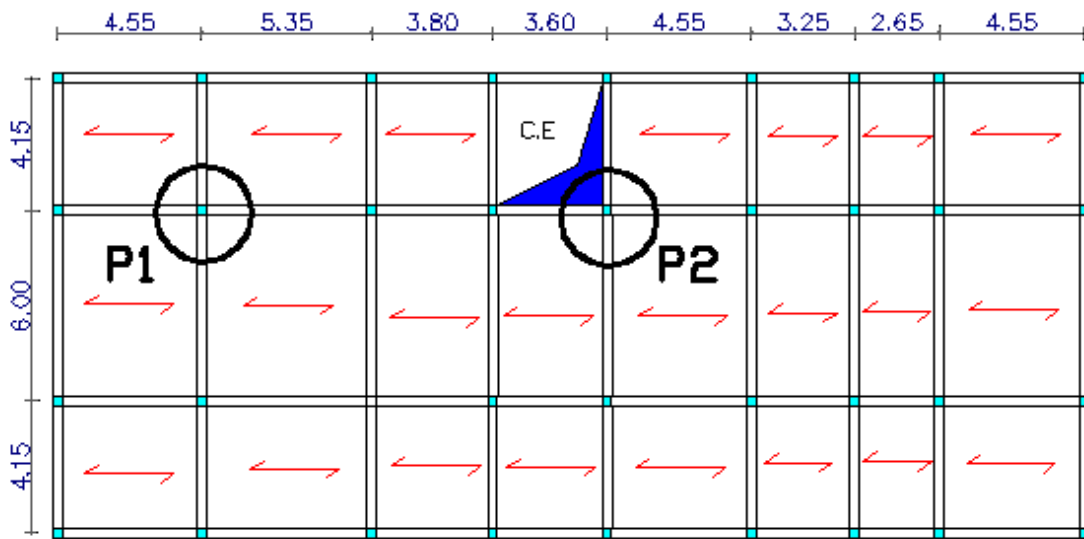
Vue en plan d'identification des poteaux de la descente de charge.
